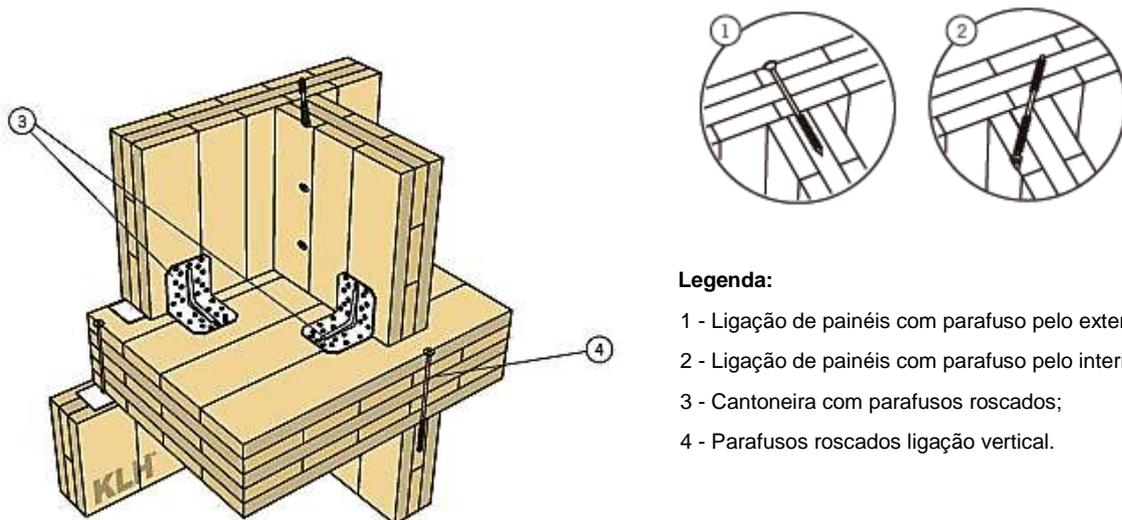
Ligação parede exterior CLT mais espessa (ligação parafusos roscados) [24]
